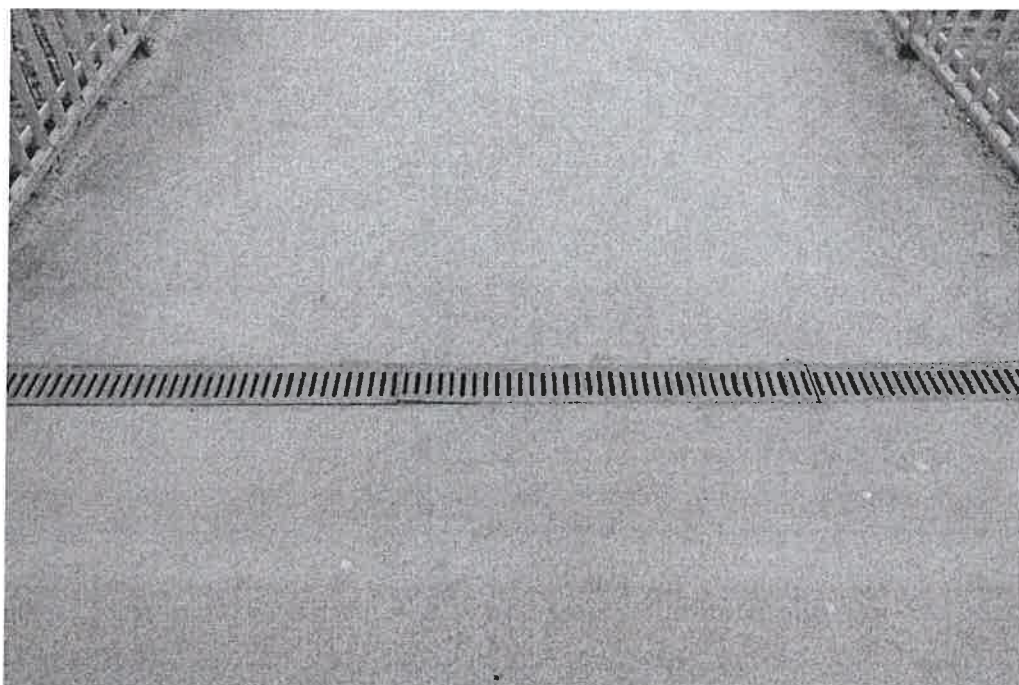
Widok ogólny przestrzeni pod obiektowej
